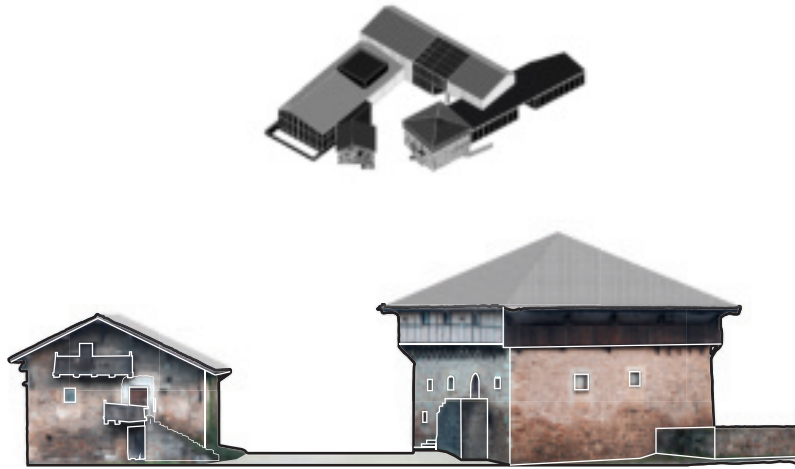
Alzado de la Torre Aranguren junto al caserío Aranguren
